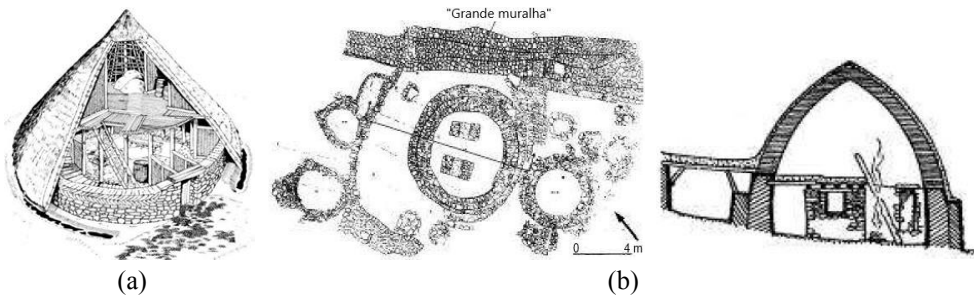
Características das primeiras construções de planta circular em alvenaria: (a) Reconstrução de uma casa redonda neolítica (a parte superior da parede do perímetro consiste em duas fiadas de tijolos assentes em espinha de peixe, Cul in Bhaile, Argyll, Escócia ocidental); (b) Planta e corte reconstrutivo do tolo I A, Choirokoitia, Chipre (VI mil. a.C.)
